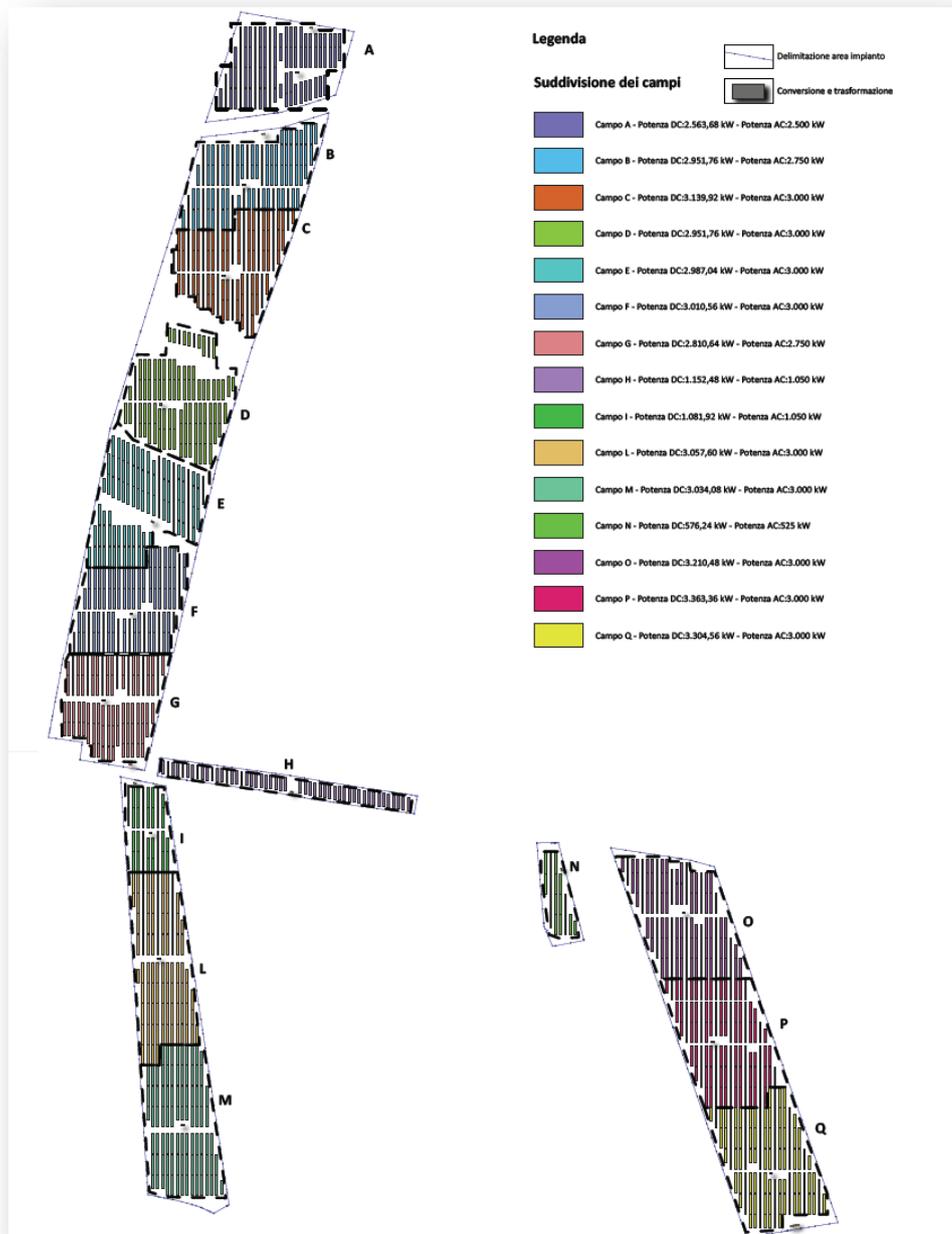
Estratto elaborato MBFAF96_GRAF_Elettrico_Q.15 (Planimetria dell'area di suddivisione dei campi)
